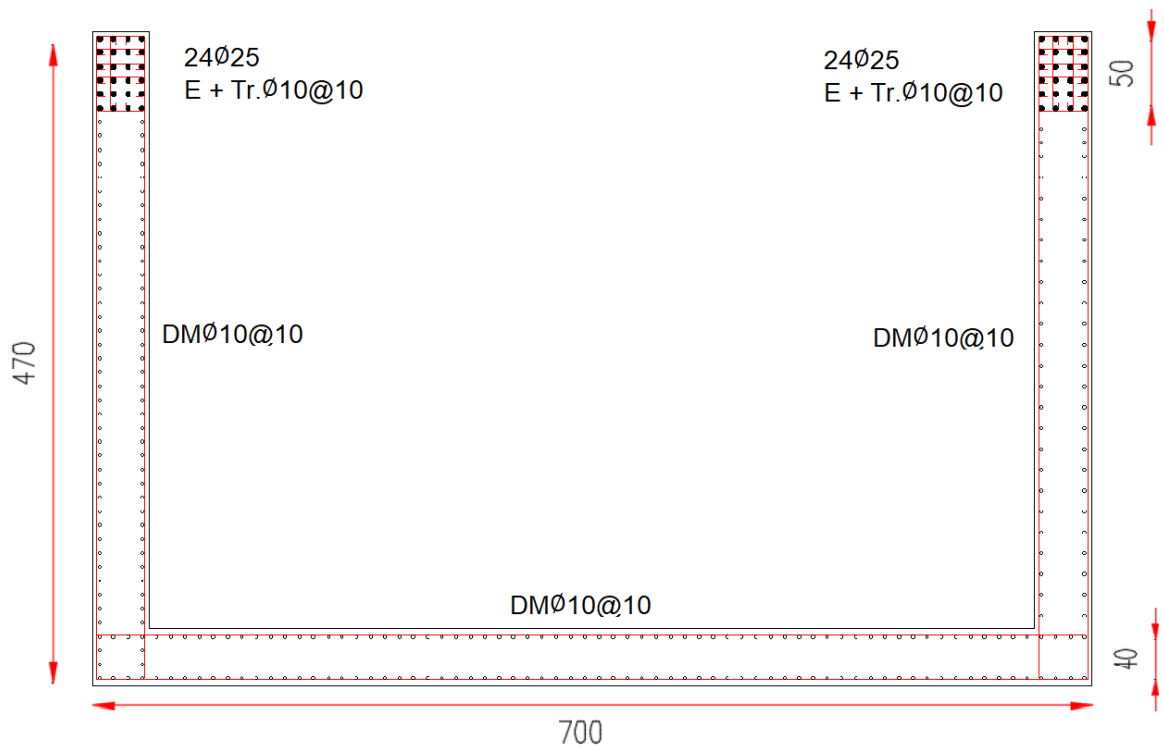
Disposición de armadura muro C modelo de 20 pisos.
